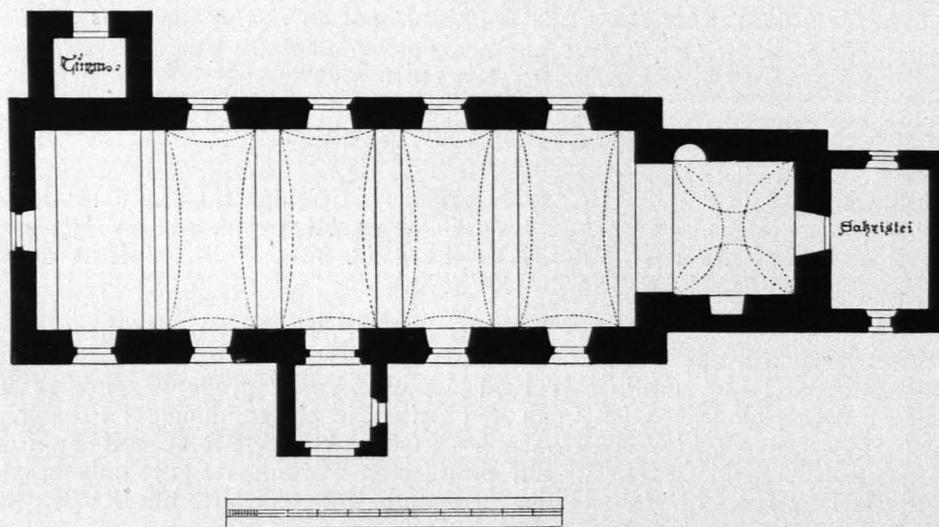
Jahrgs, Pfarrkirche, Grundriß 1:250 (S. 342)
